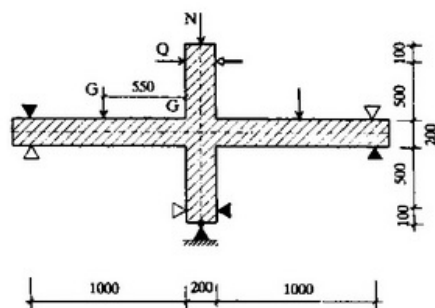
Схема испытания железобетонного фрагмента многоэтажного здания на гравитационную и боковую нагрузки
